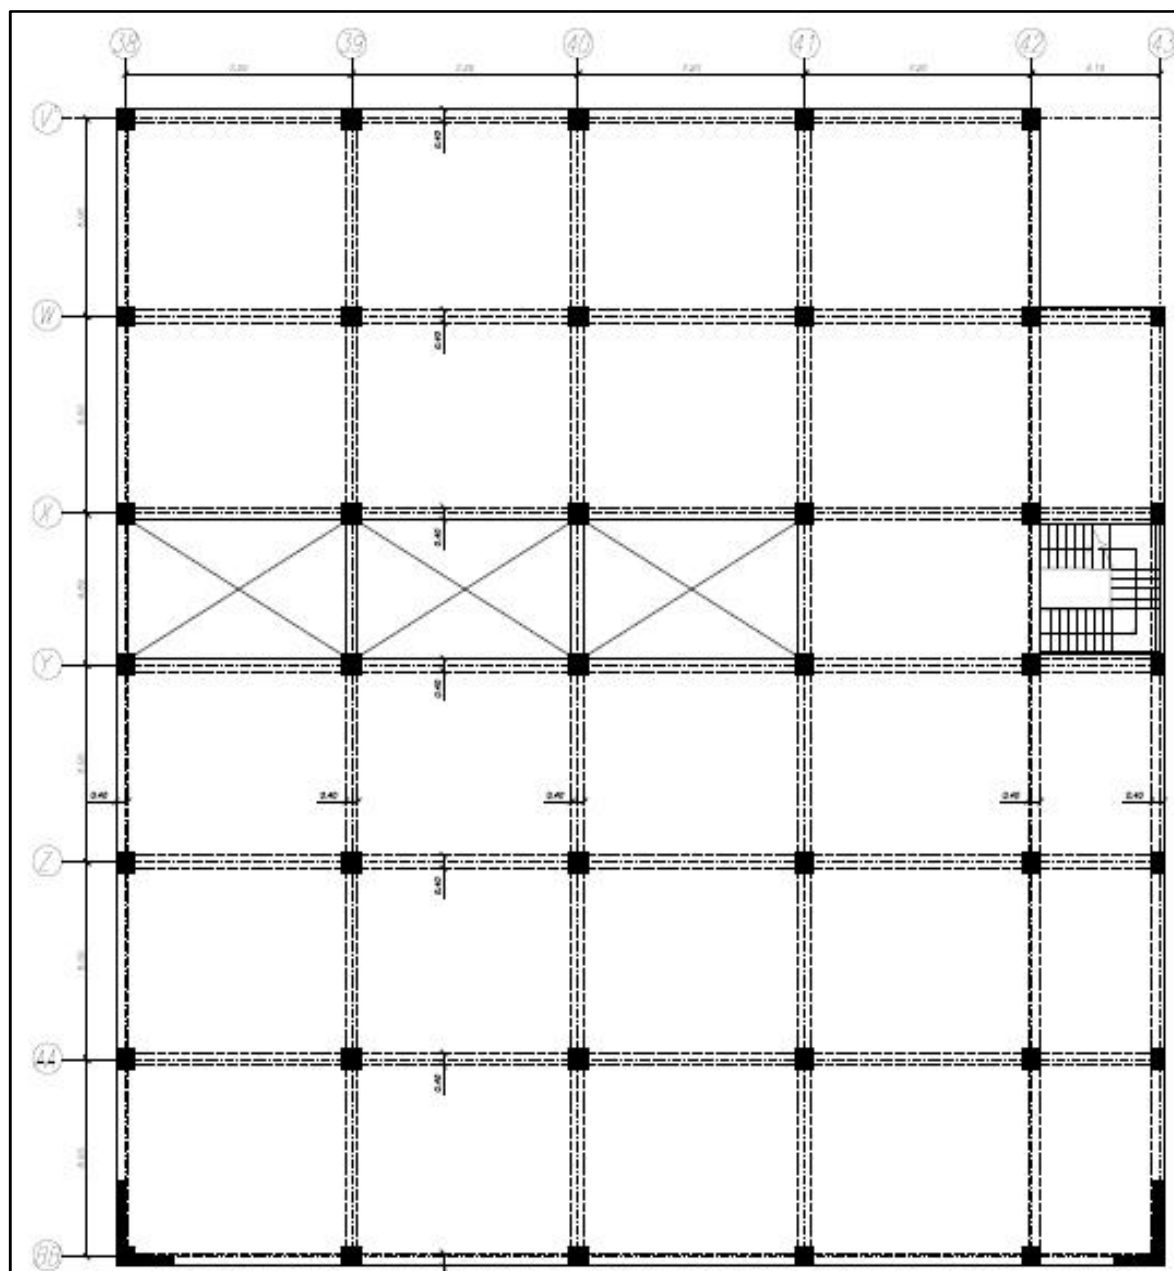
Planta estructural N+3.96, Consulta Externa II
